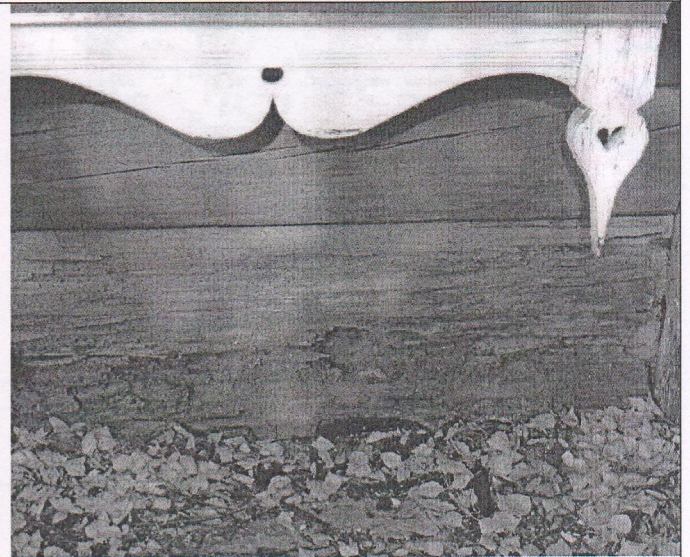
Дефекты нижних венцов сруба со стороны северного фасада.
